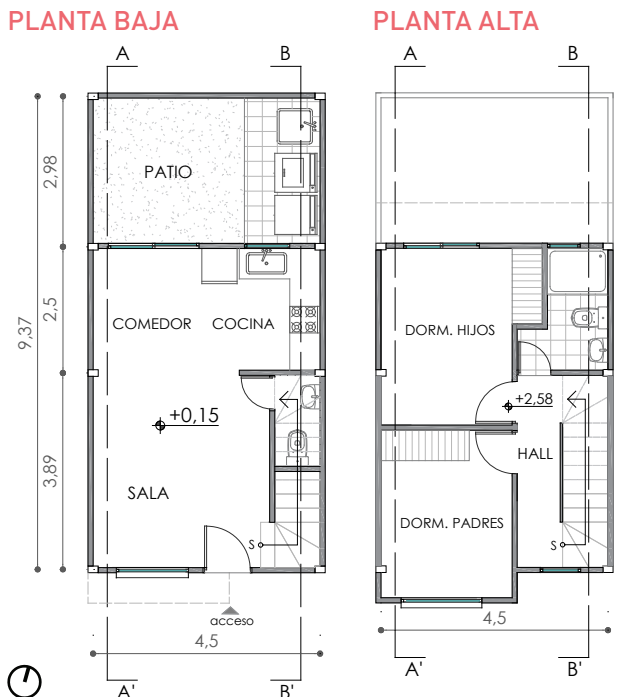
Plantas arquitectónicas vivienda esquinera suroeste
